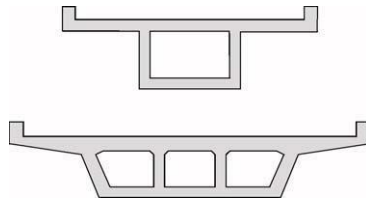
Sección Transversal del puente Tipo 03, Viga Cajón
